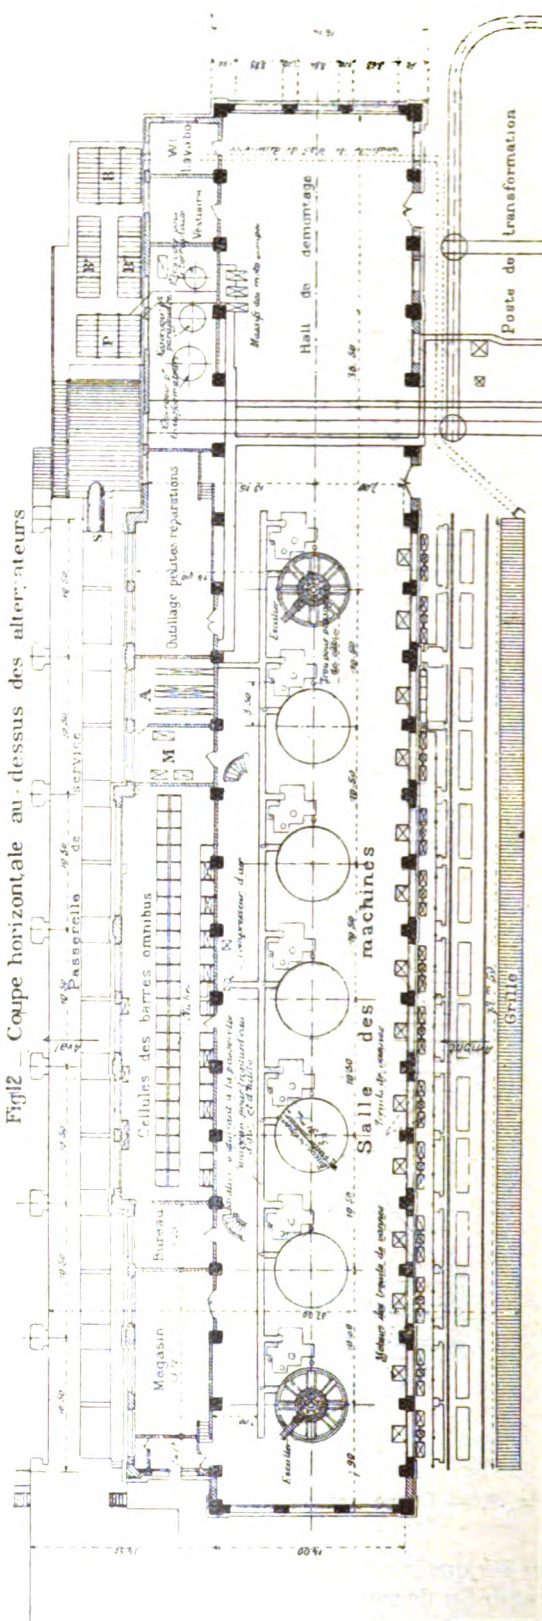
et 12. — Coupe verticale et coupe horizontale de l'usine de Beaumont-Monteux.
